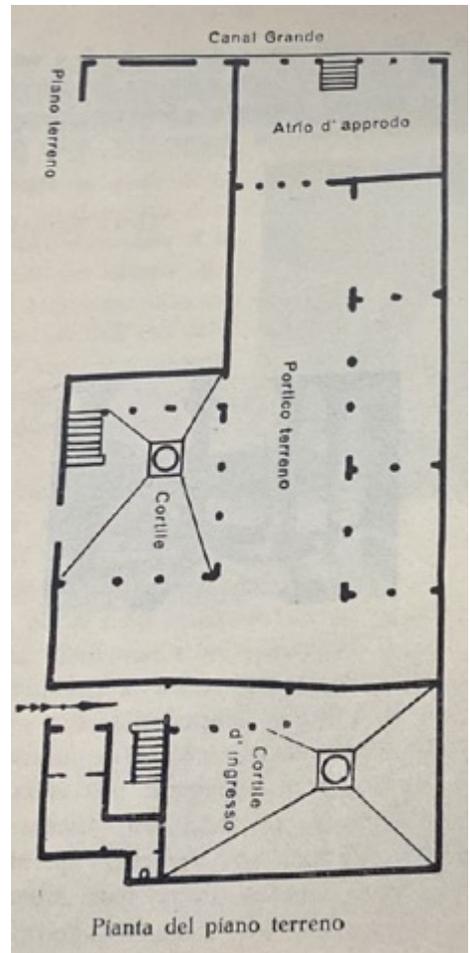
Pianta del piano terra dopo il restauro di Giorgio Franchetti.
